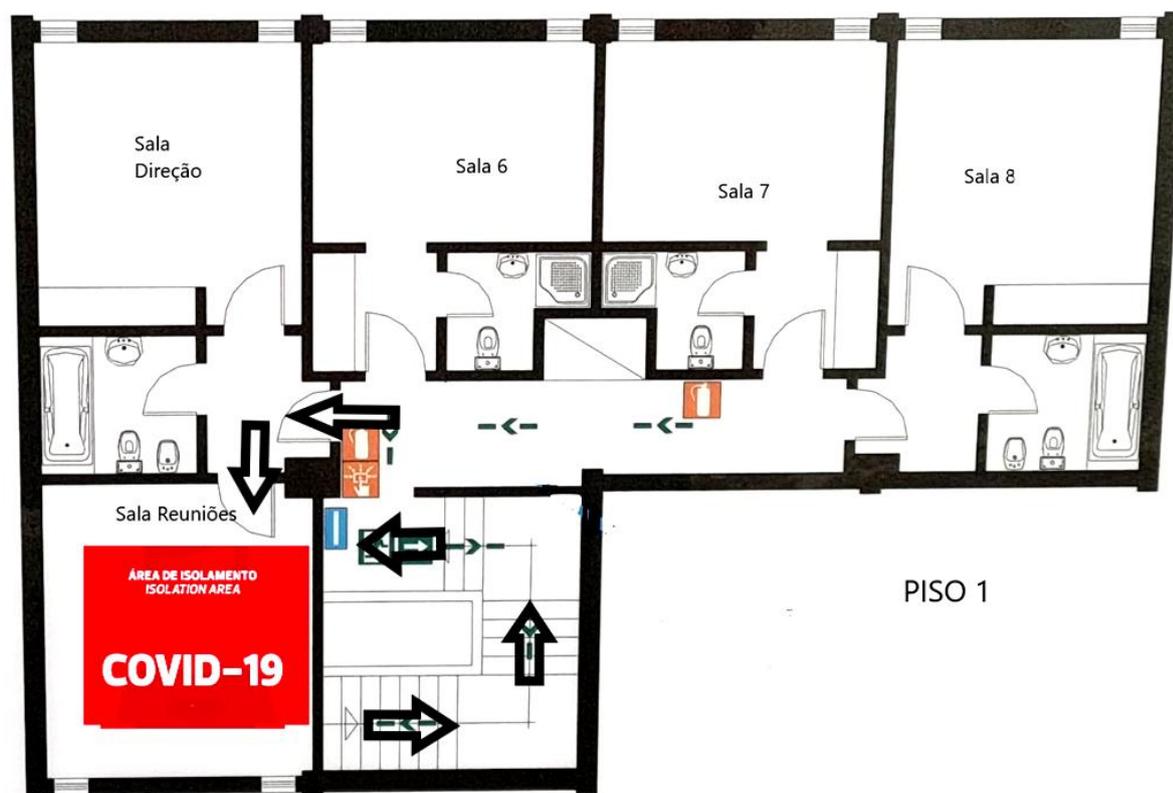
Planta do Piso 1 com indicação da Sala de Isolamento.
